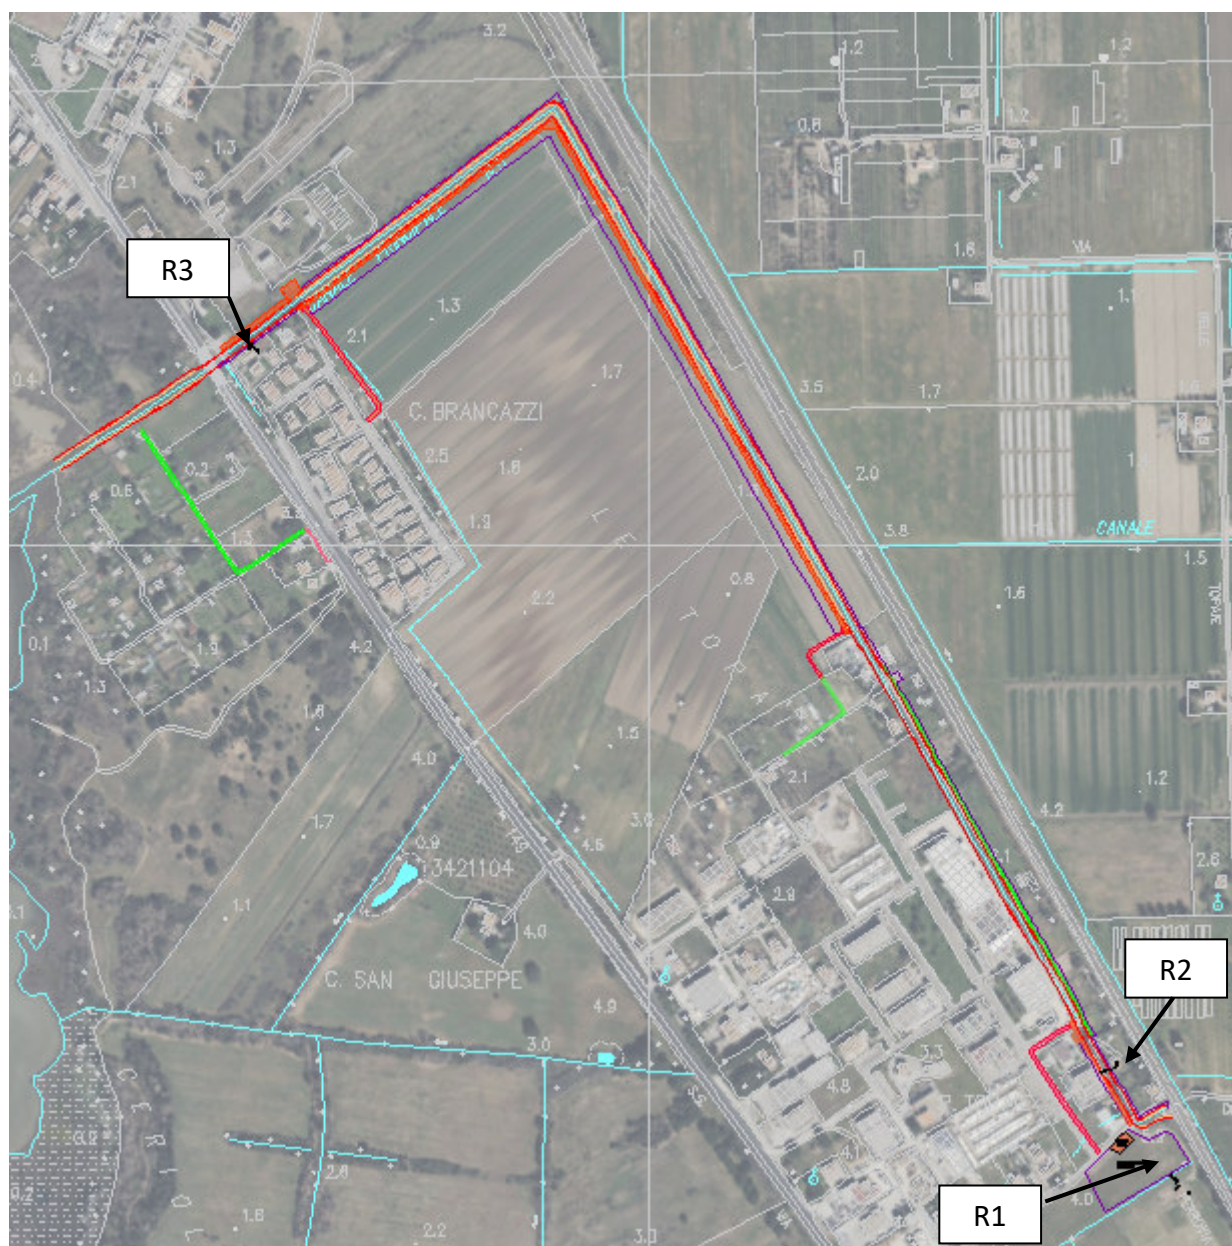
Individuazione sulla planimetria generale dei tre ricettori individuati
